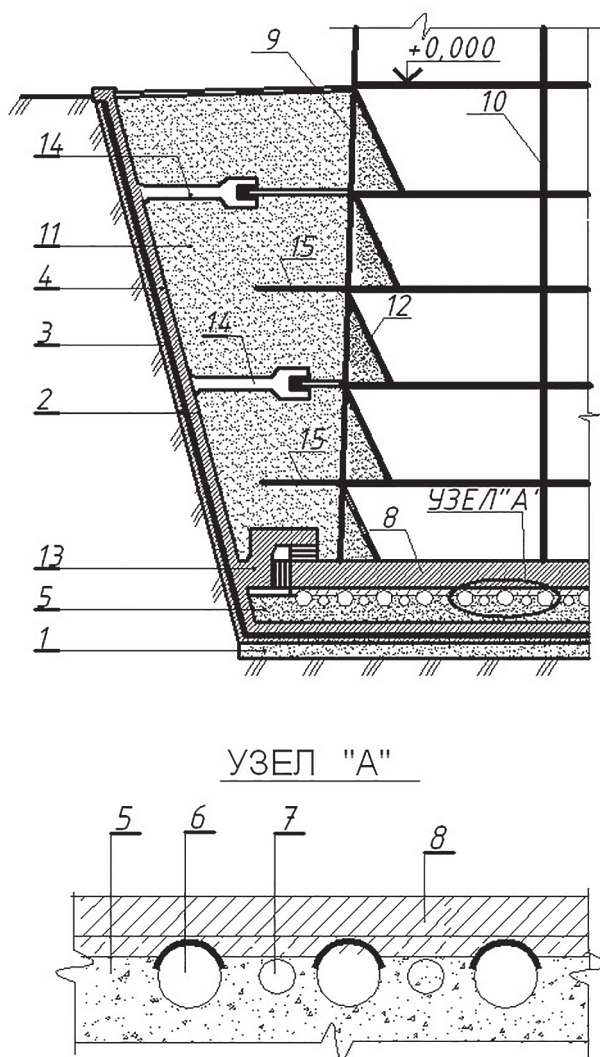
Фрагмент поперечного разреза здания, защитного экрана и котлована [12,13]
